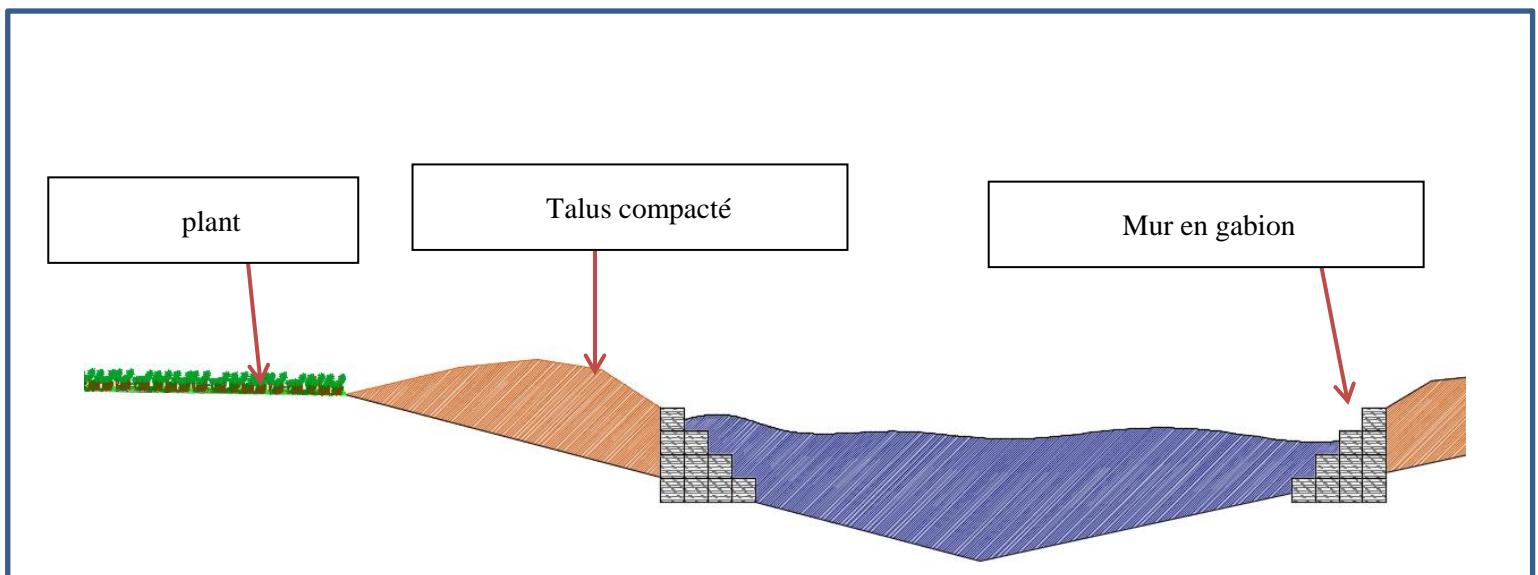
une coupe schematique montre le positionnement des éléments de protection, source: auteur
